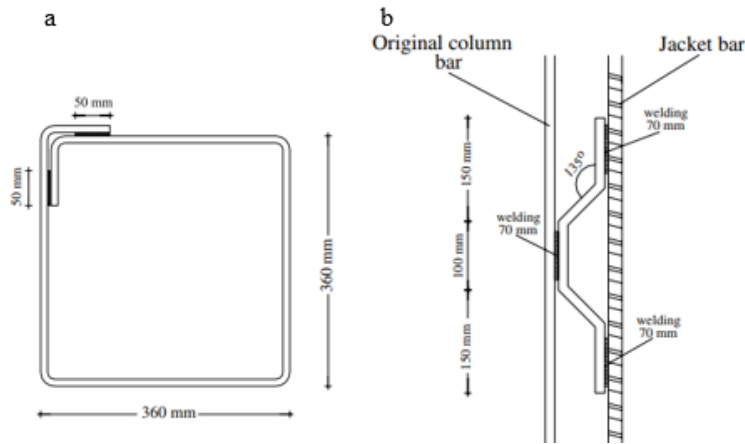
Técnicas utilizadas para encamisar las columnas de Vandoros y Dritsos (2006)
